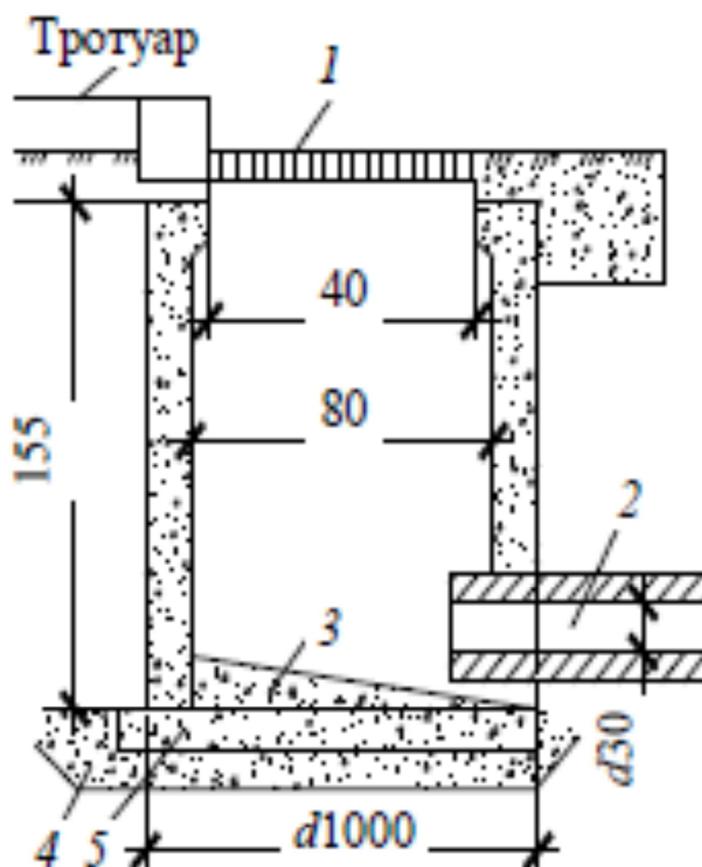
Схема устройства железобетонного дождеприемника: 1 – приемная решетка; 2 – соединительная ветка; 3 – лоток с набивкой; 4 – песчаная подушка; 5 – основание (размеры даны в см)
